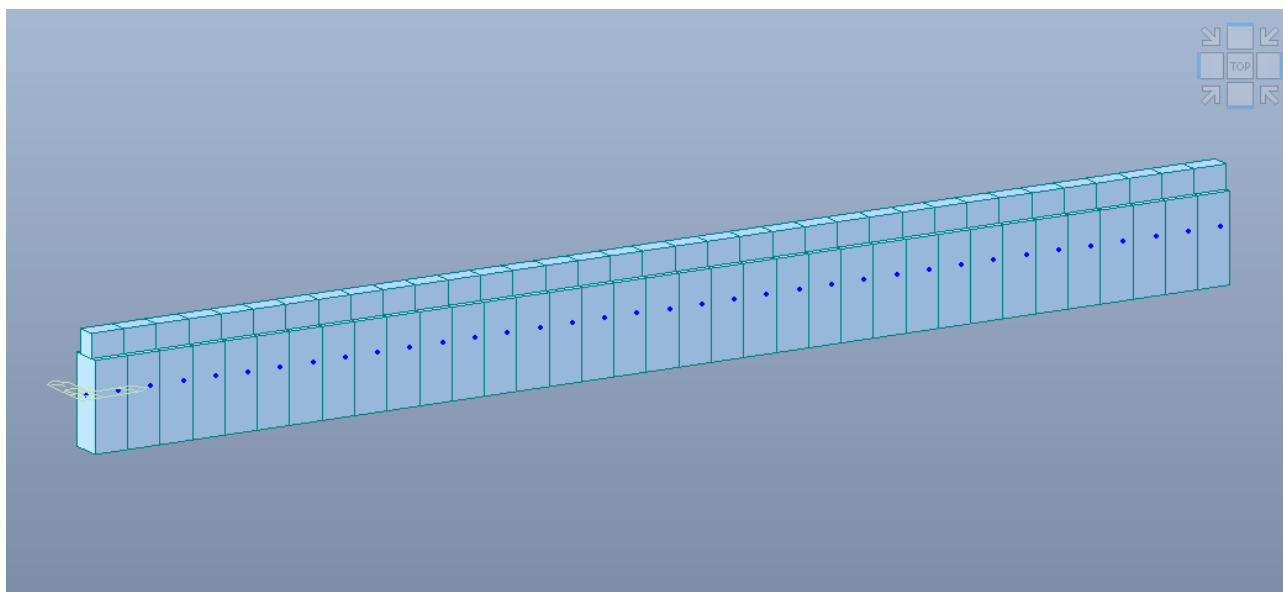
Schema con applicazione dei carichi – trave tipo 2
